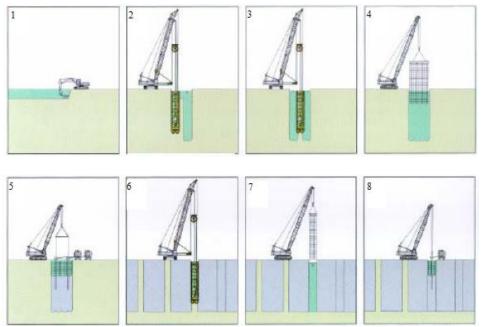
Construcción del muro pantalla; Fuente: Civilserve Academy, Mayo 2008.
